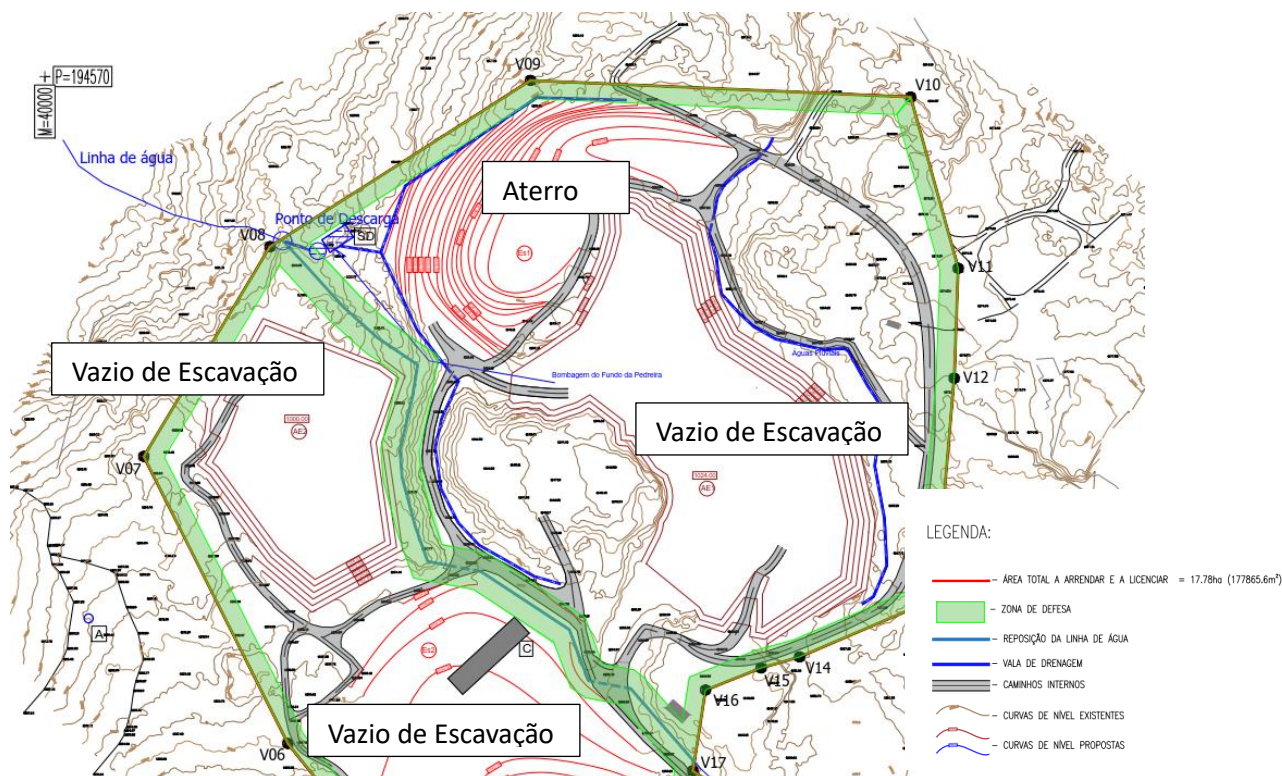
Excerto da Planta de Drenagem para a pedreira “Fraga do Carvalhoto” (Fonte: Plano de Pedreira).
